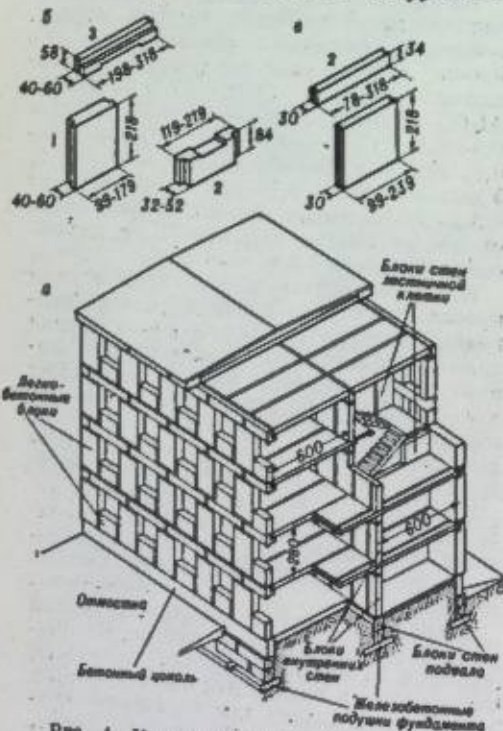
Крупноблочный жилой дом с двухрядной разрезкой: а — общая схема конструкции; б — типы блоков наружных стен (1 — простеночный; 2 — подоконный вкладыш; 3 — перемычковый); в — типы блоков внутренних стен (1 — основной; 2 — полнотелый).
